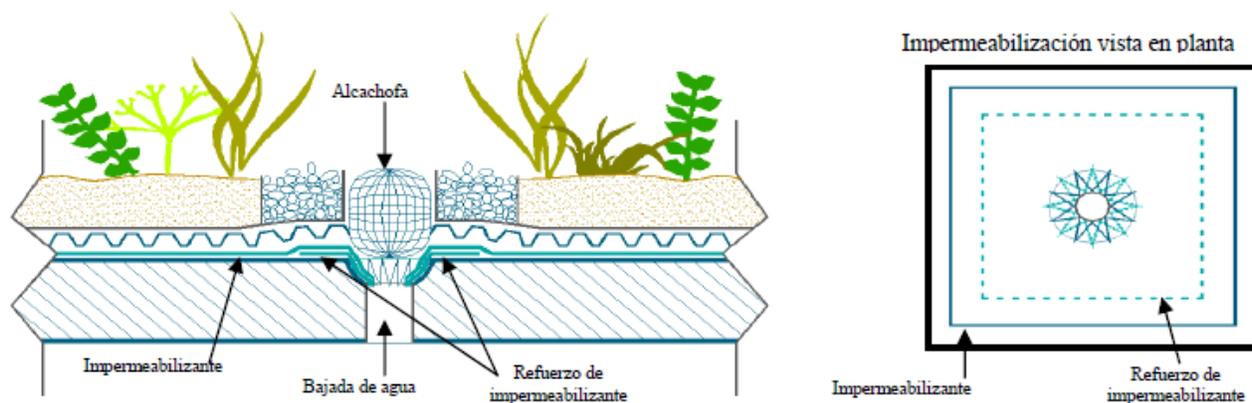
Impermeabilización y refuerzo en puntos de encuentro con bajadas de agua.
